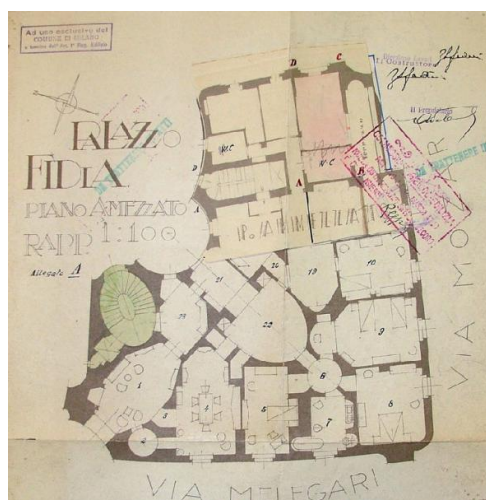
Aldo Andreani. Palazzo Fidia. Pianta (Archivio Civico Milano, Edilizia Privata)
